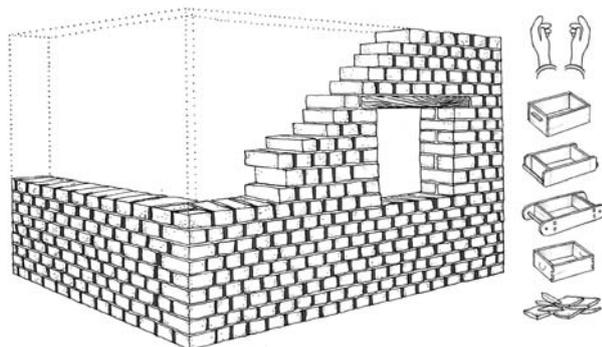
Fábrica de adobe con juntas enripiadas con lajas de piedra.
